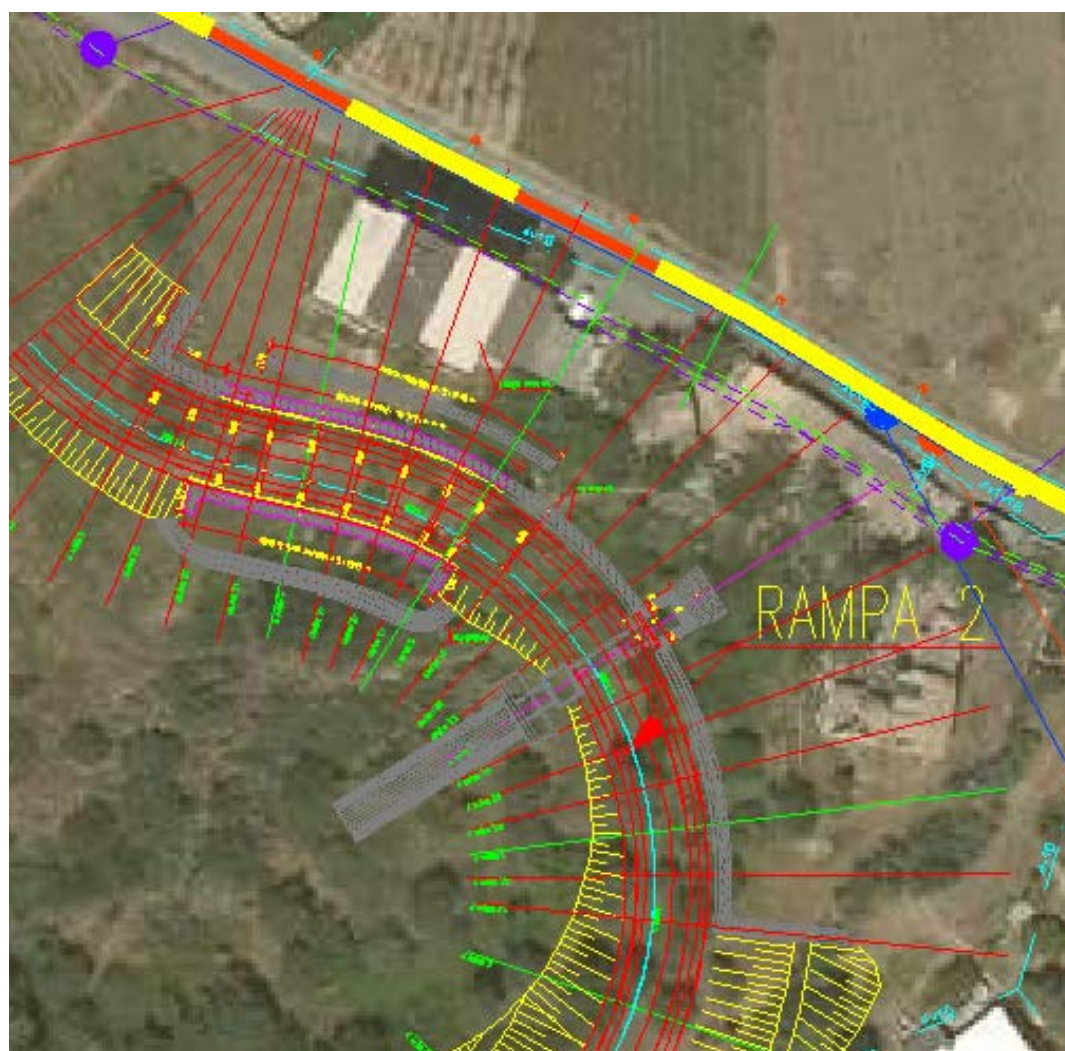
Stralcio planimetrico dell'opera con indicazioni sottoservizi
